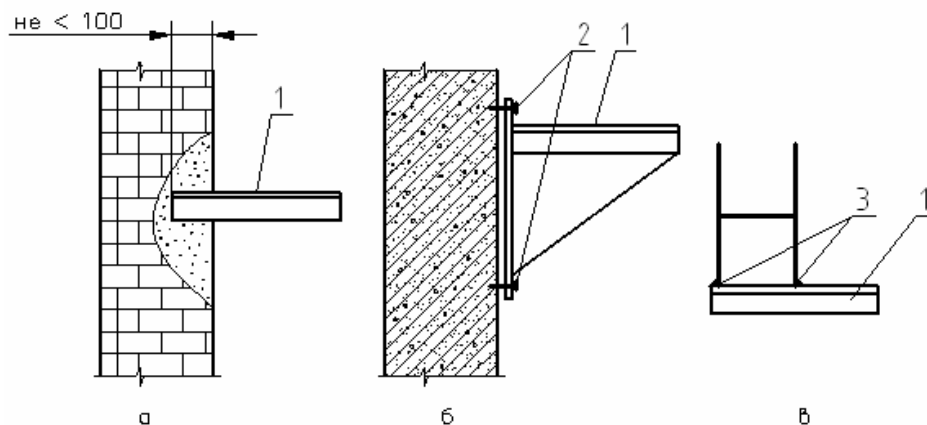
Установка кронштейнов для крепления трубопроводов: а – в кирпичной стене; б – в бетонных конструкциях; в – в металлических конструкциях; 1 – кронштейн из уголка; 2 – дюбель-гвозди; 3 – места сварки
